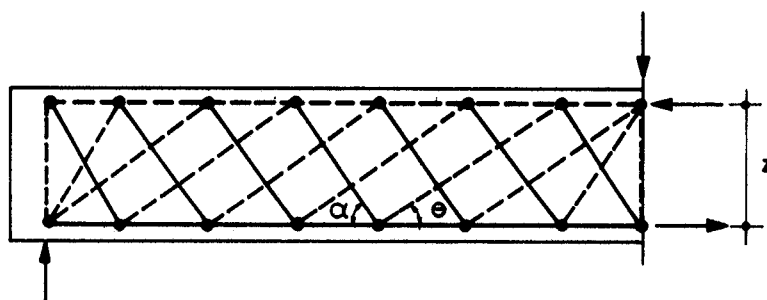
MODELO PARA VIGA DE CONCRETO ARMADO COM BANZOS PARALELOS - FORÇA CONCENTRADA - CEB/90⁵
